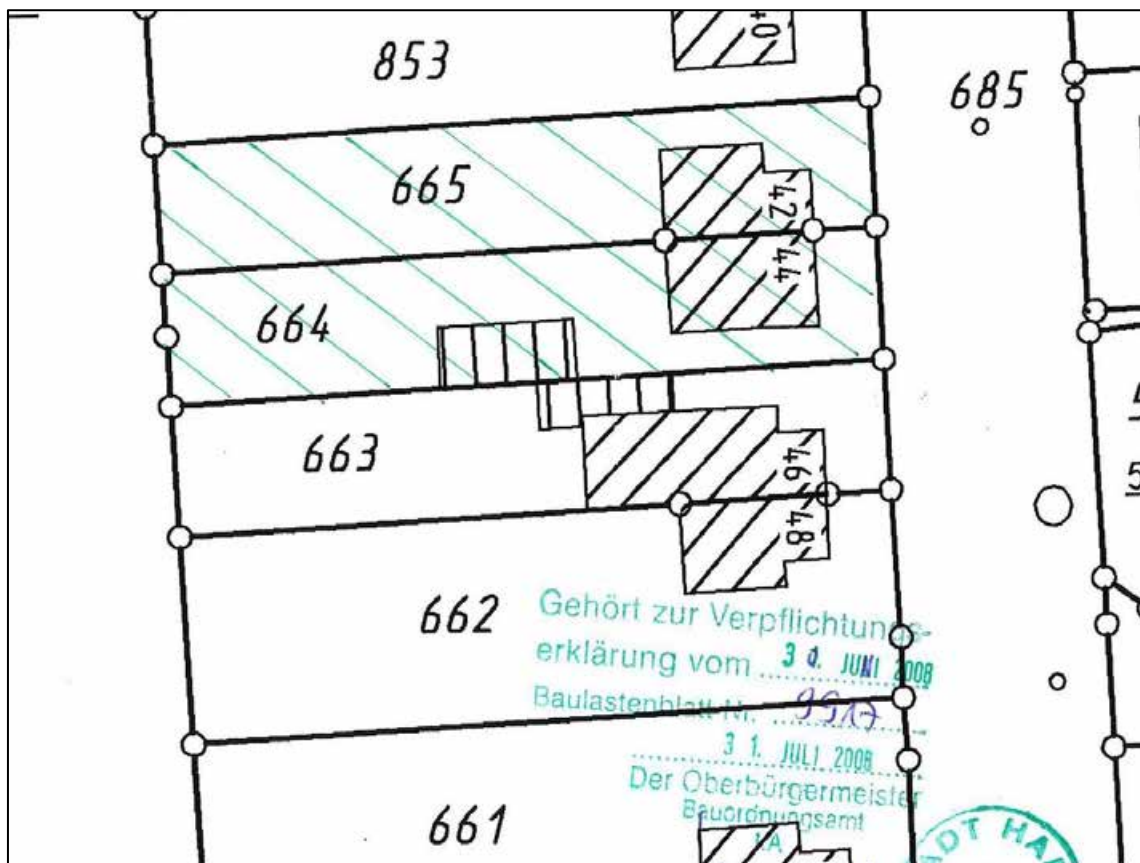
Auszug aus dem Lageplan zur Baulast 9917
